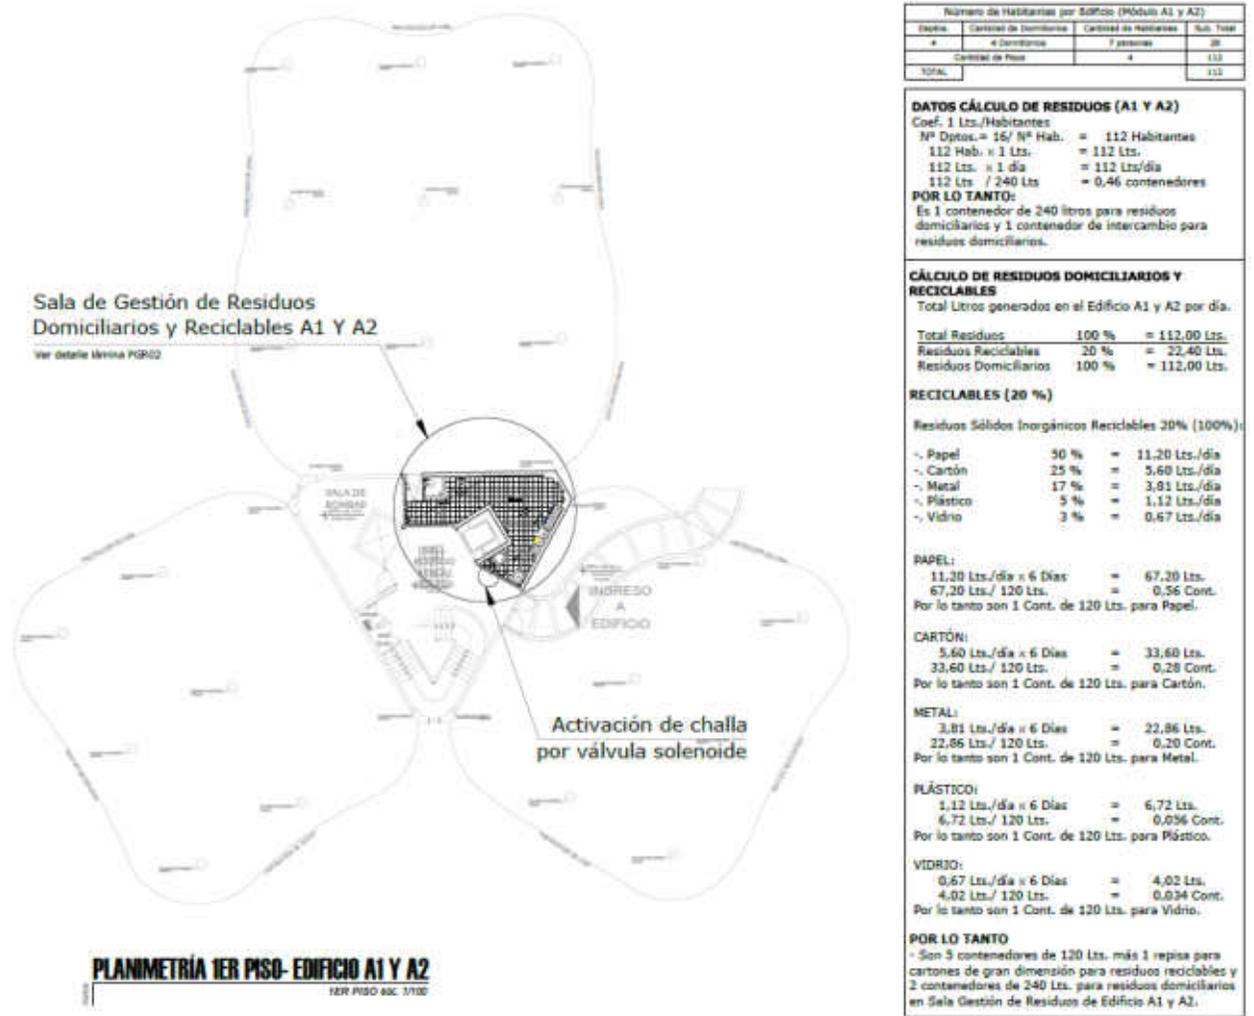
PSGR - Planimetría 1er Piso – Edificio A1 y A2 – Datos de cálculo de Residuos
